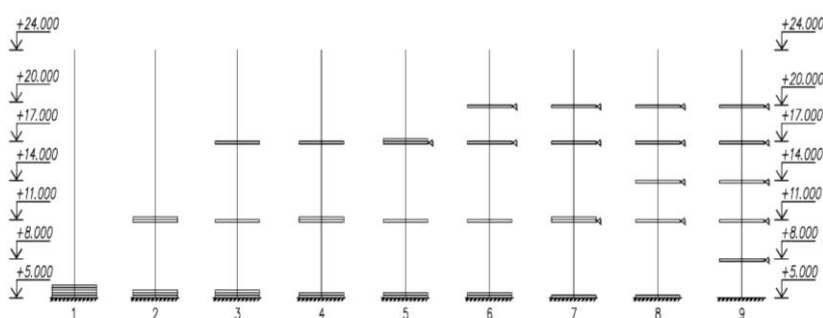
Монтажная схема подъема плит перекрытия на проектные отметки
